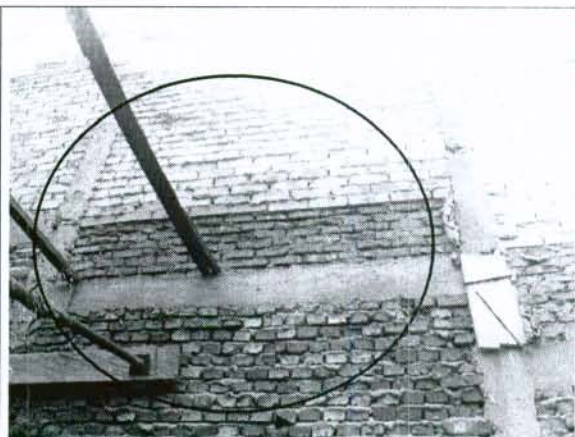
Apuntalamiento del muro de cerramiento del Conjunto "Oasis de Santa Inés".
